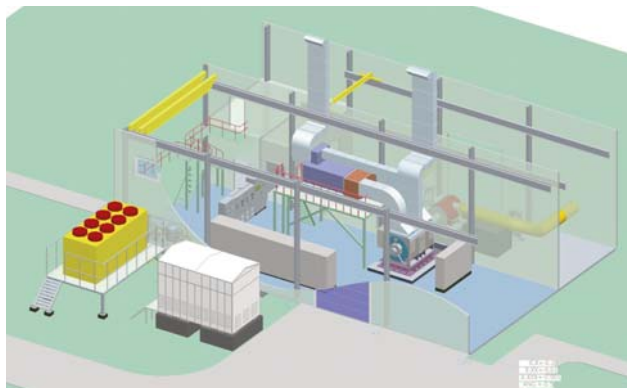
Трехмерная модель компоновки основного оборудования компрессорной станции ЭГПА-6,3
